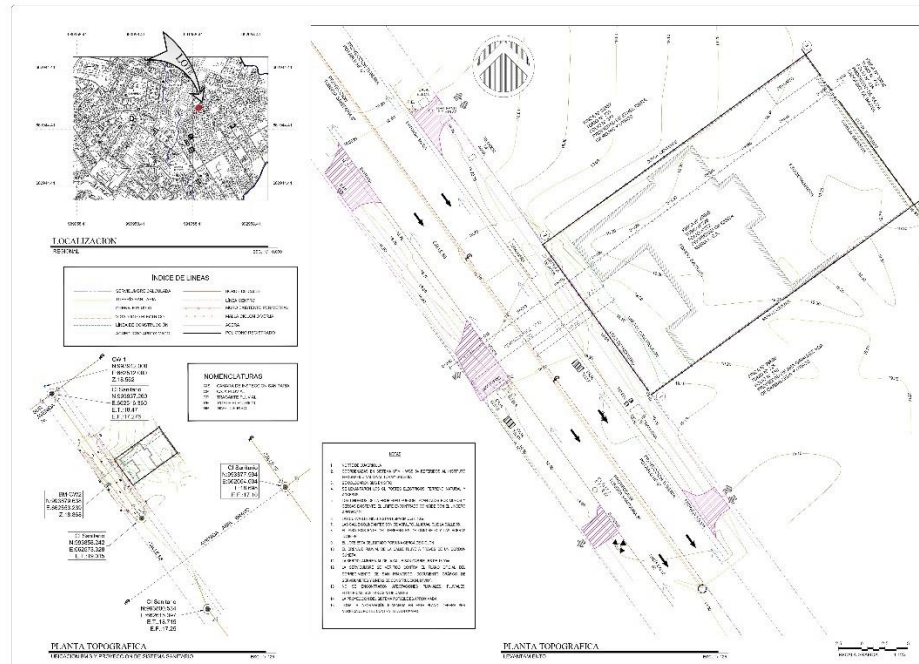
Copia de levantamiento topográfico. Fuente: Levantamiento topográfico Empresa Geodinamics.10 de septiembre de 2024.
